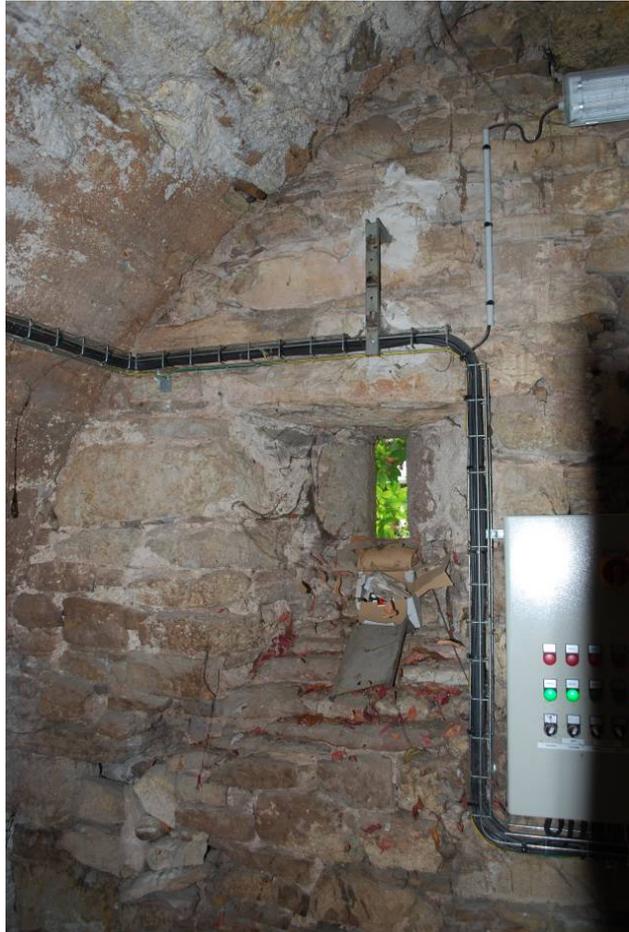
L'aile de communs nord-ouest, rez-de-chaussée, cave centrale, jour dans le mur sud.
